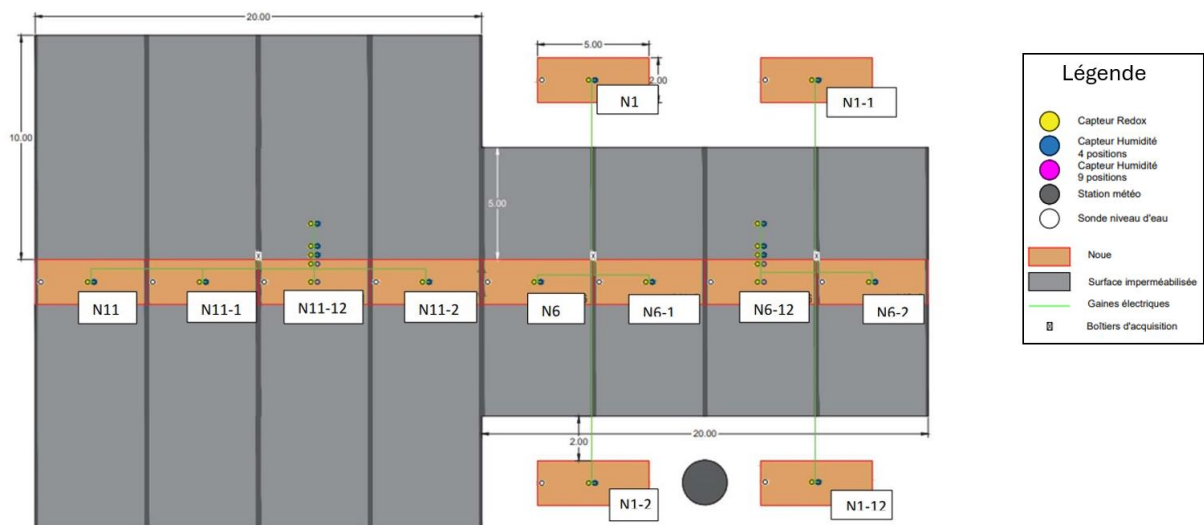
Vue en plan du positionnement de l'instrumentation sur le site
